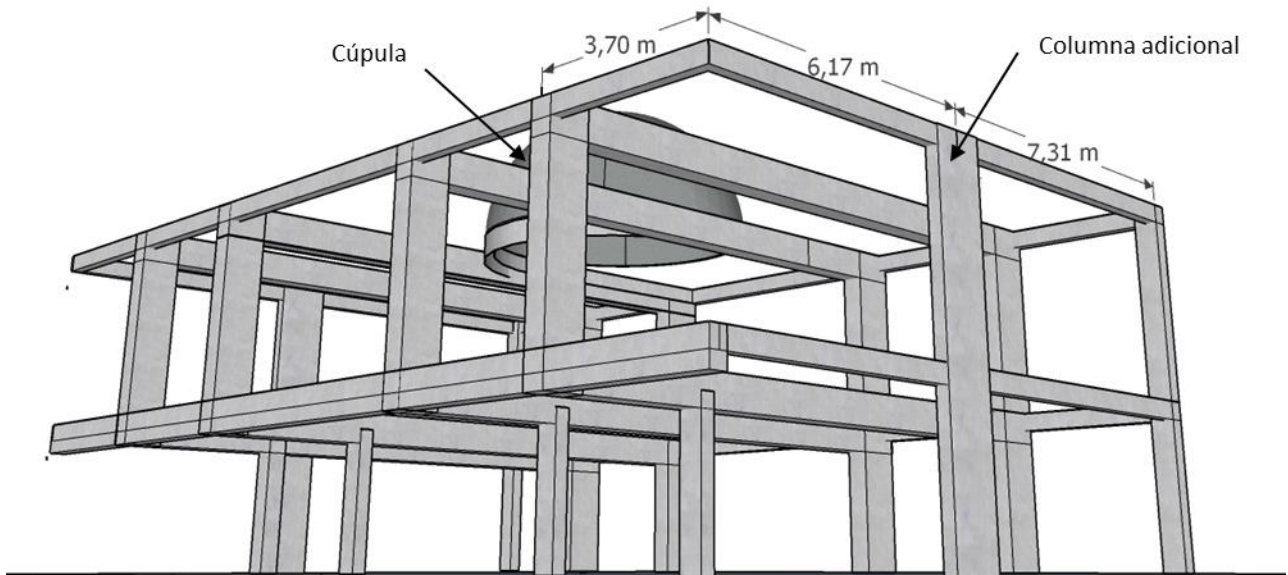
Esquema de vigas y columnas del volumen del foyer reforzado y reformado por Barón & Macchi.
